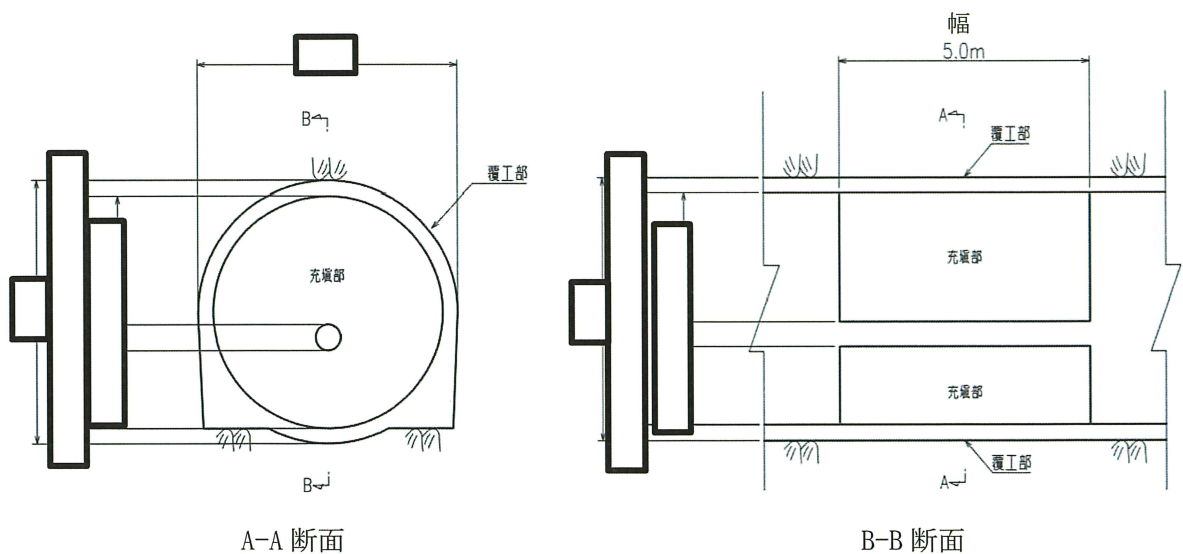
(2) 取放水路流路縮小工（第1号機放水路） 断面図
